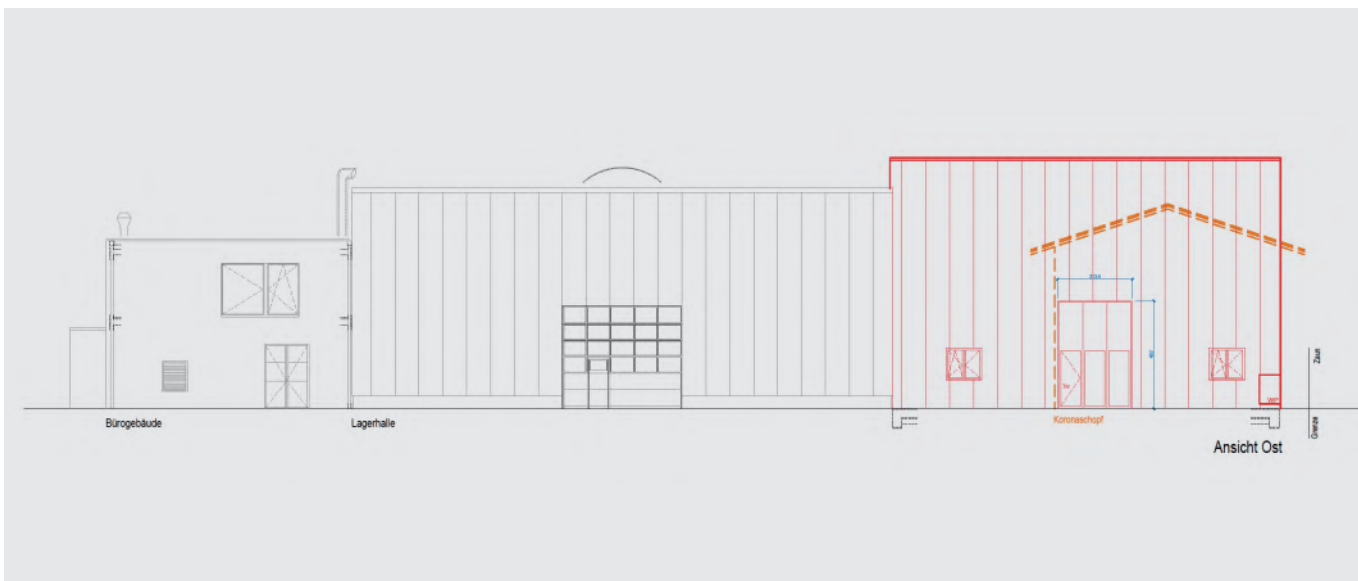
Bauvorhaben Ersatzbau Prüfhalle/Mehrzweckhalle (Ansicht Ost)
